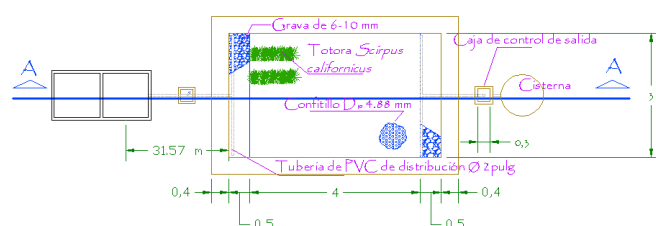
Vista de planta del sistema de tratamiento (B. Villafranca, R. Miglio). Se ven en esta figura solamente dos cámaras de sedimentación porque en el proyecto inicial solo se tenían dos cámaras y un atrapagrasas. Luego de operar unos meses, las tuberías de entrada al humedal comenzaron a atorarse, y entonces se decidió instalar una cámara de sedimentación adicional.
